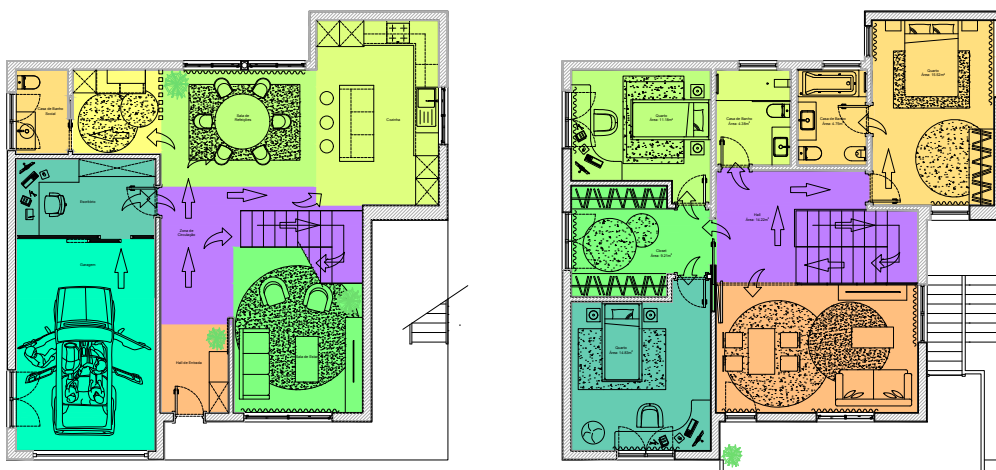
Planta de zonamentos e circulação - Rés de Chão e Piso 1
